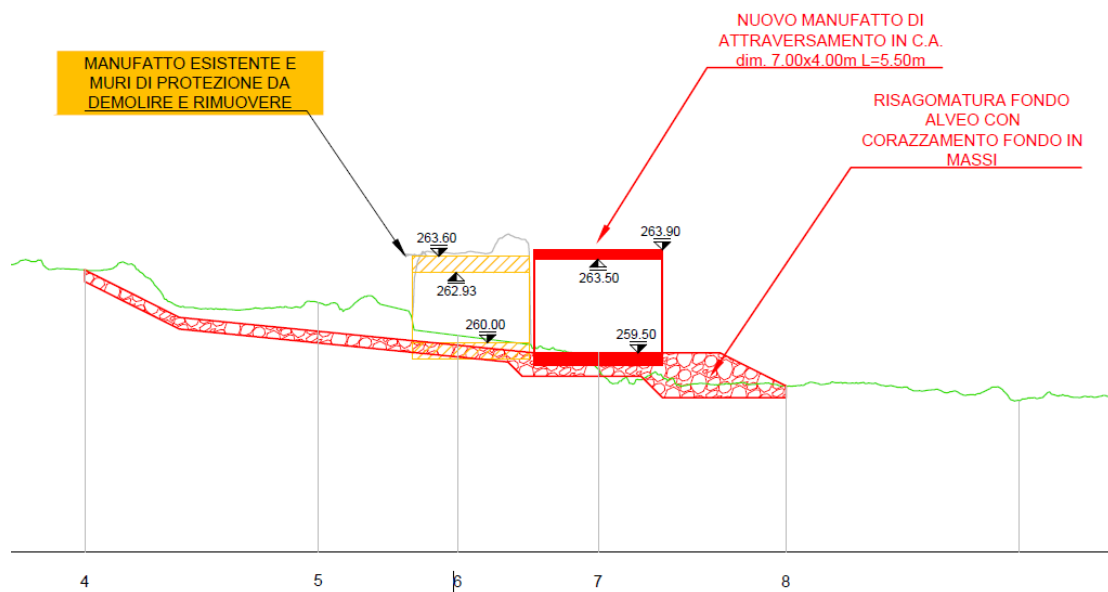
Profilo longitudinale del Rio Briccola in corrispondenza del nuovo attraversamento stradale (nella planimetria sopra è indicata la traccia del profilo. Il riquadro arancione rappresenta la luce di passaggio del ponte, caratterizzata da una quota di scorrimento pari a 259,5 m s.m. e da una quota di intradosso pari a 263,50 m s.m.
